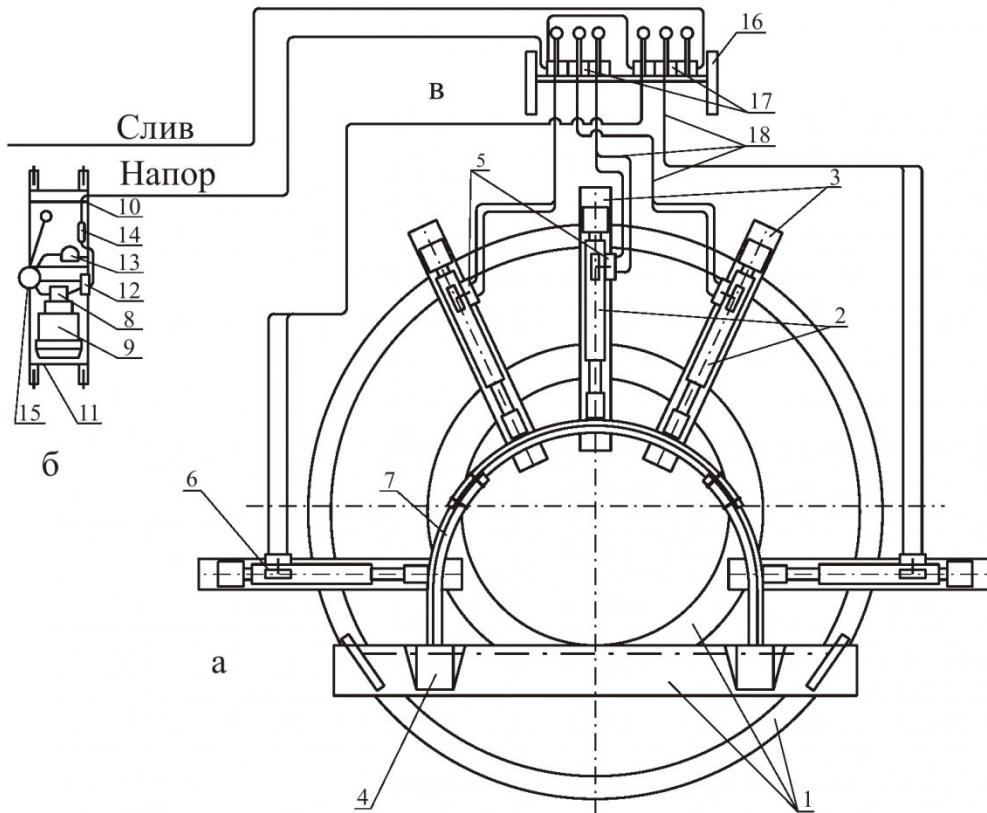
Испытательный горизонтальный стенд ОАО «КузНИИшахтострой»: а – силовой блок; б – маслостанция; в – пульт управления; 1 – опорная металлоконструкция; 2 – силовые гидроцилиндры; 3 – опорные балки гидроцилиндров; 4 – передвижные опорные башмаки стоек крепи; 5 – гидрозамки; 6 – образцовые манометры; 7 – металлическая рамная крепь; 8 – насос; 9 – электродвигатель; 10 – маслобак; 11 – рама; 12 – предохранительно-переливной клапан; 13 – дроссель; 14 – манометр; 15 – фильтр; 16 – каркас; 17 – гидрораспределители; 18 – рукава высоконапорные
